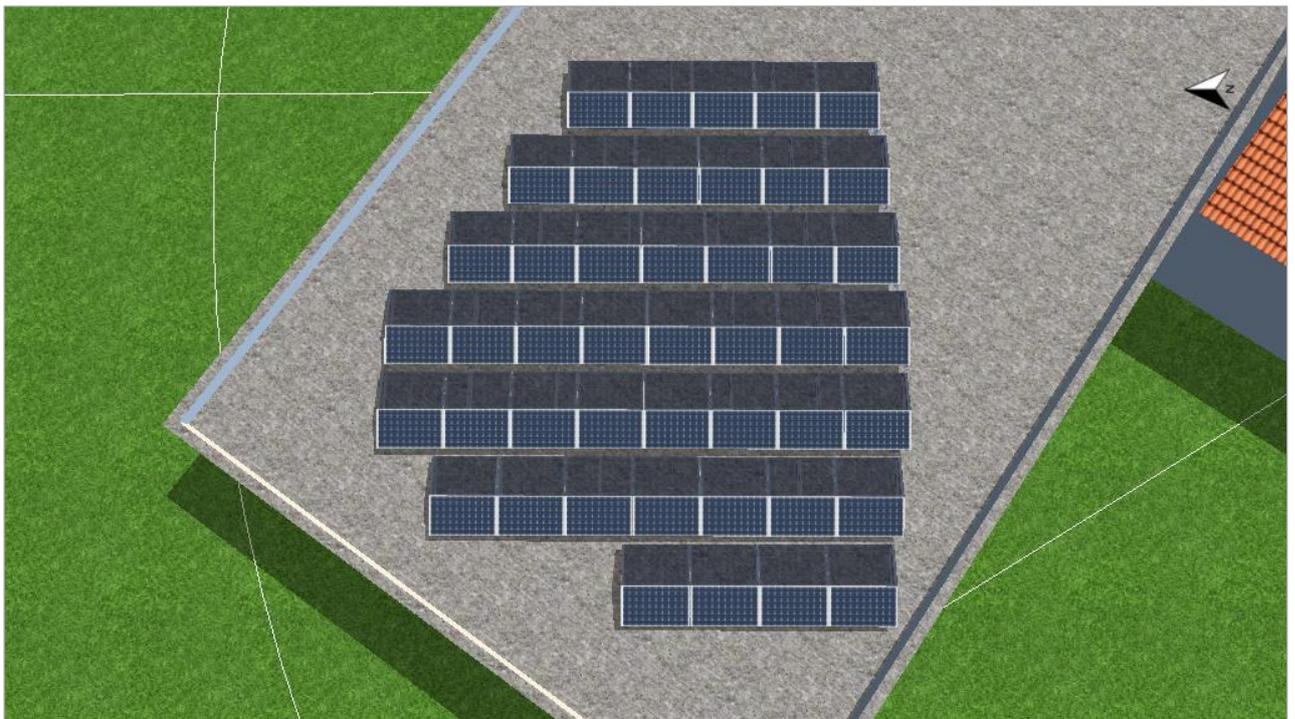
Modulfläche - Gebäude 03-Modulfläche West
